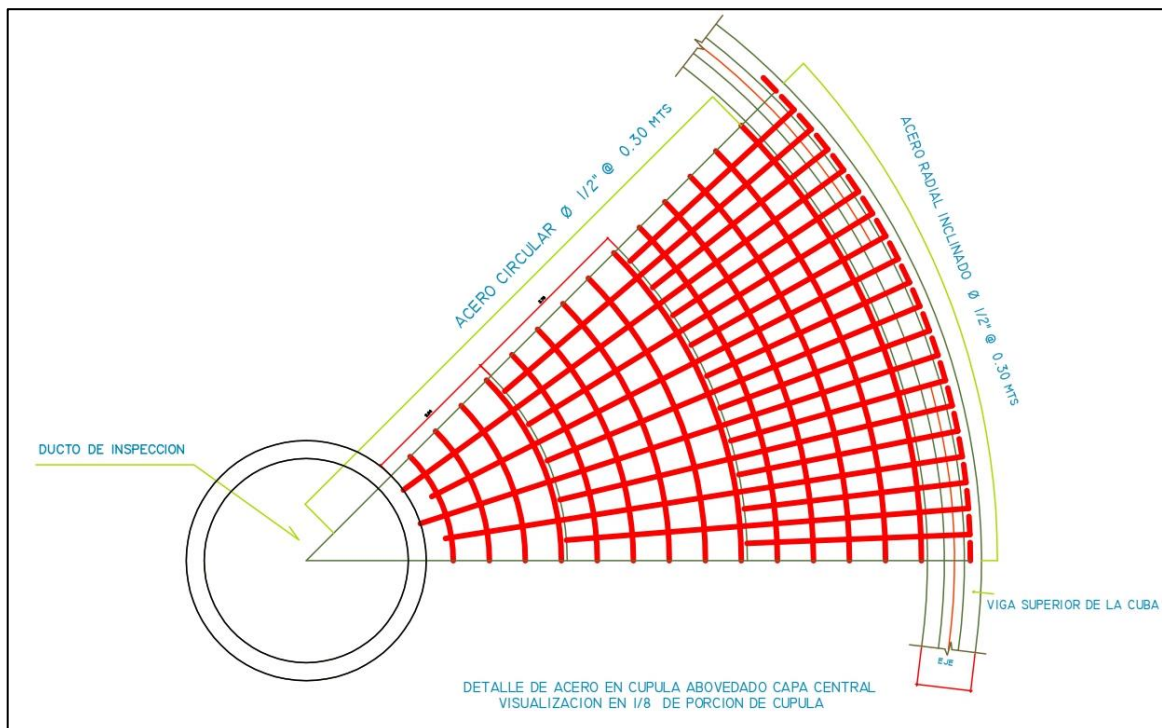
Plano en planta de detalle de distribución de acero en la cúpula superior.
